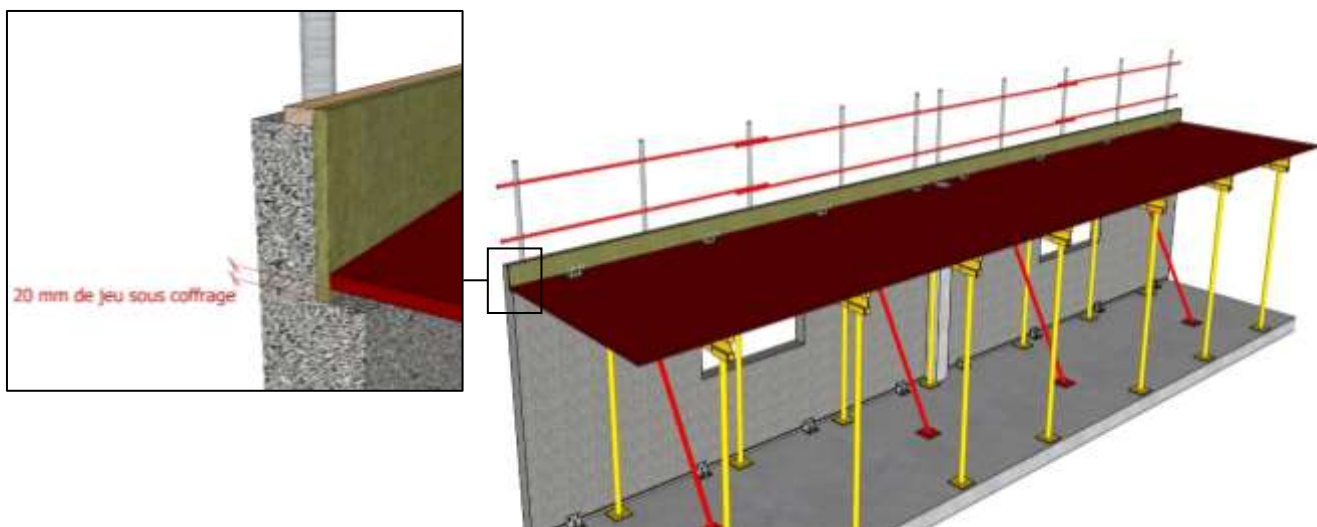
Mise en place du coffrage de la dalle béton (FP3)
